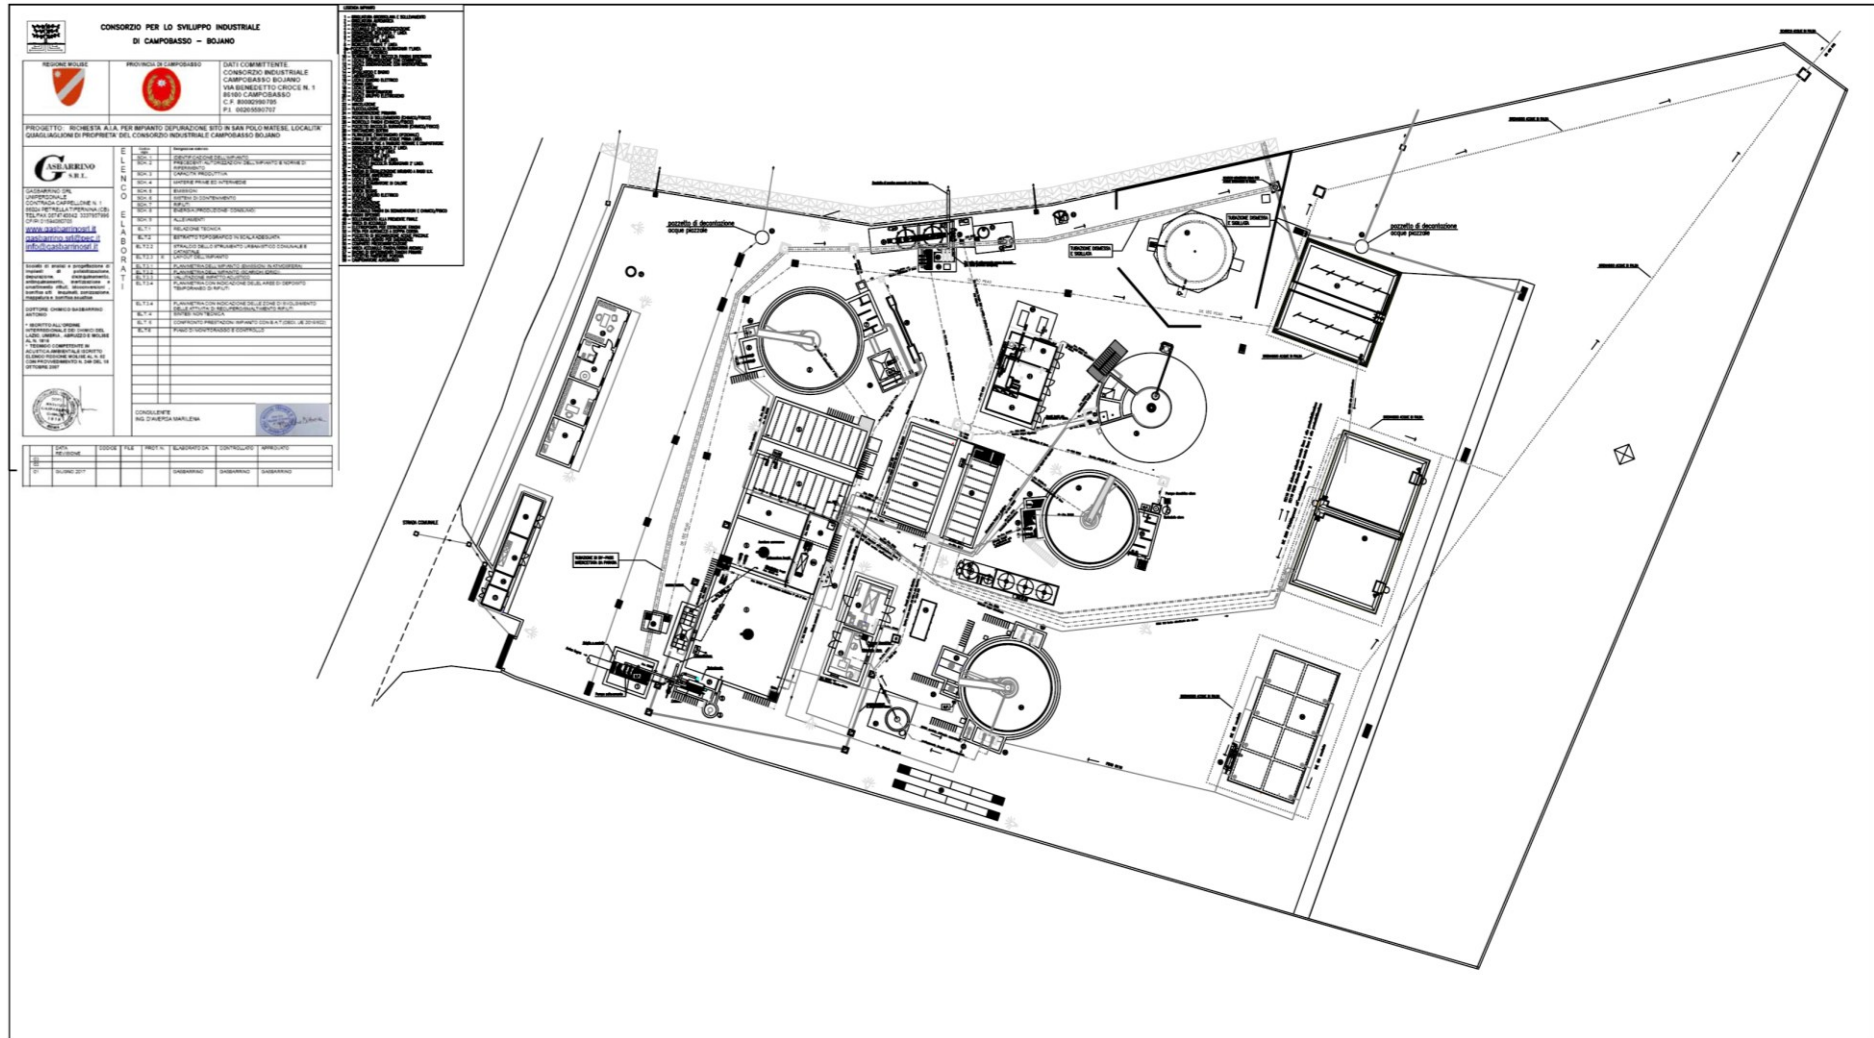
planimetria generale dell’installazione: assetto “ante operam”
